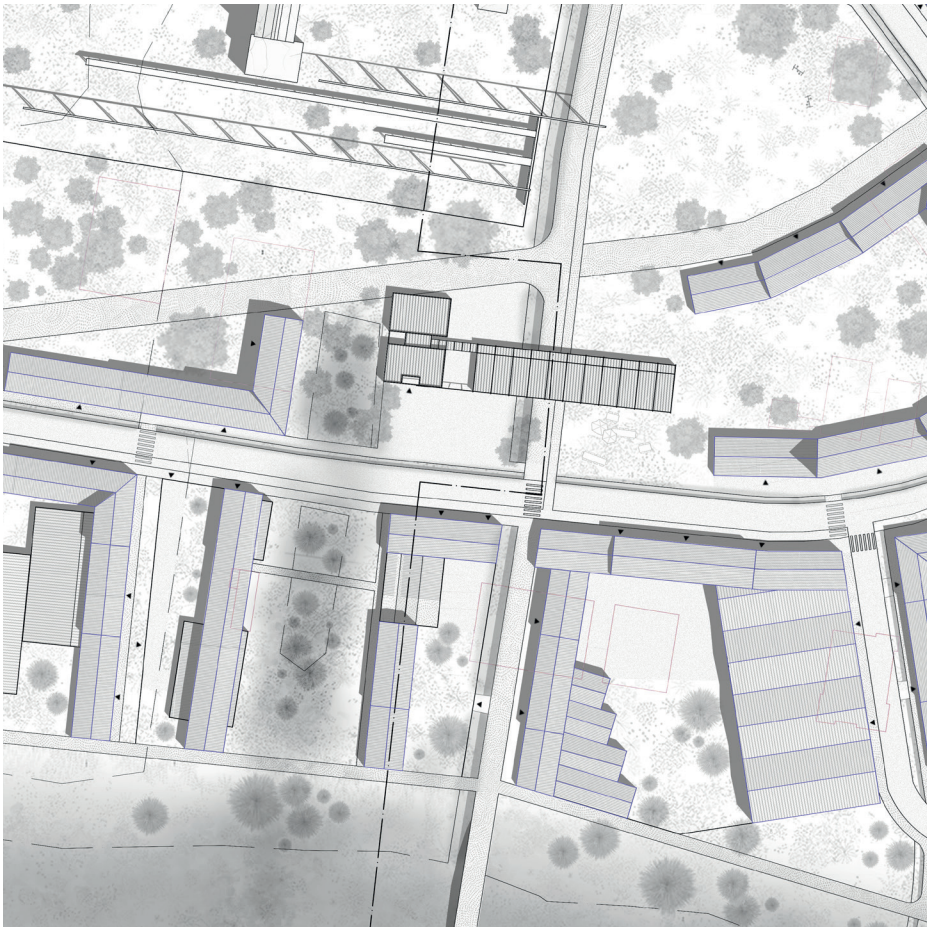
Cadrage sur le tissu mixte (Bord du Brivet)
